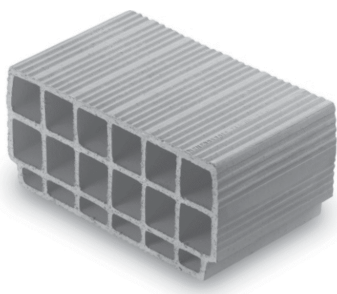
Esempio di blocco di laterizio per solaio a travetti⁴
